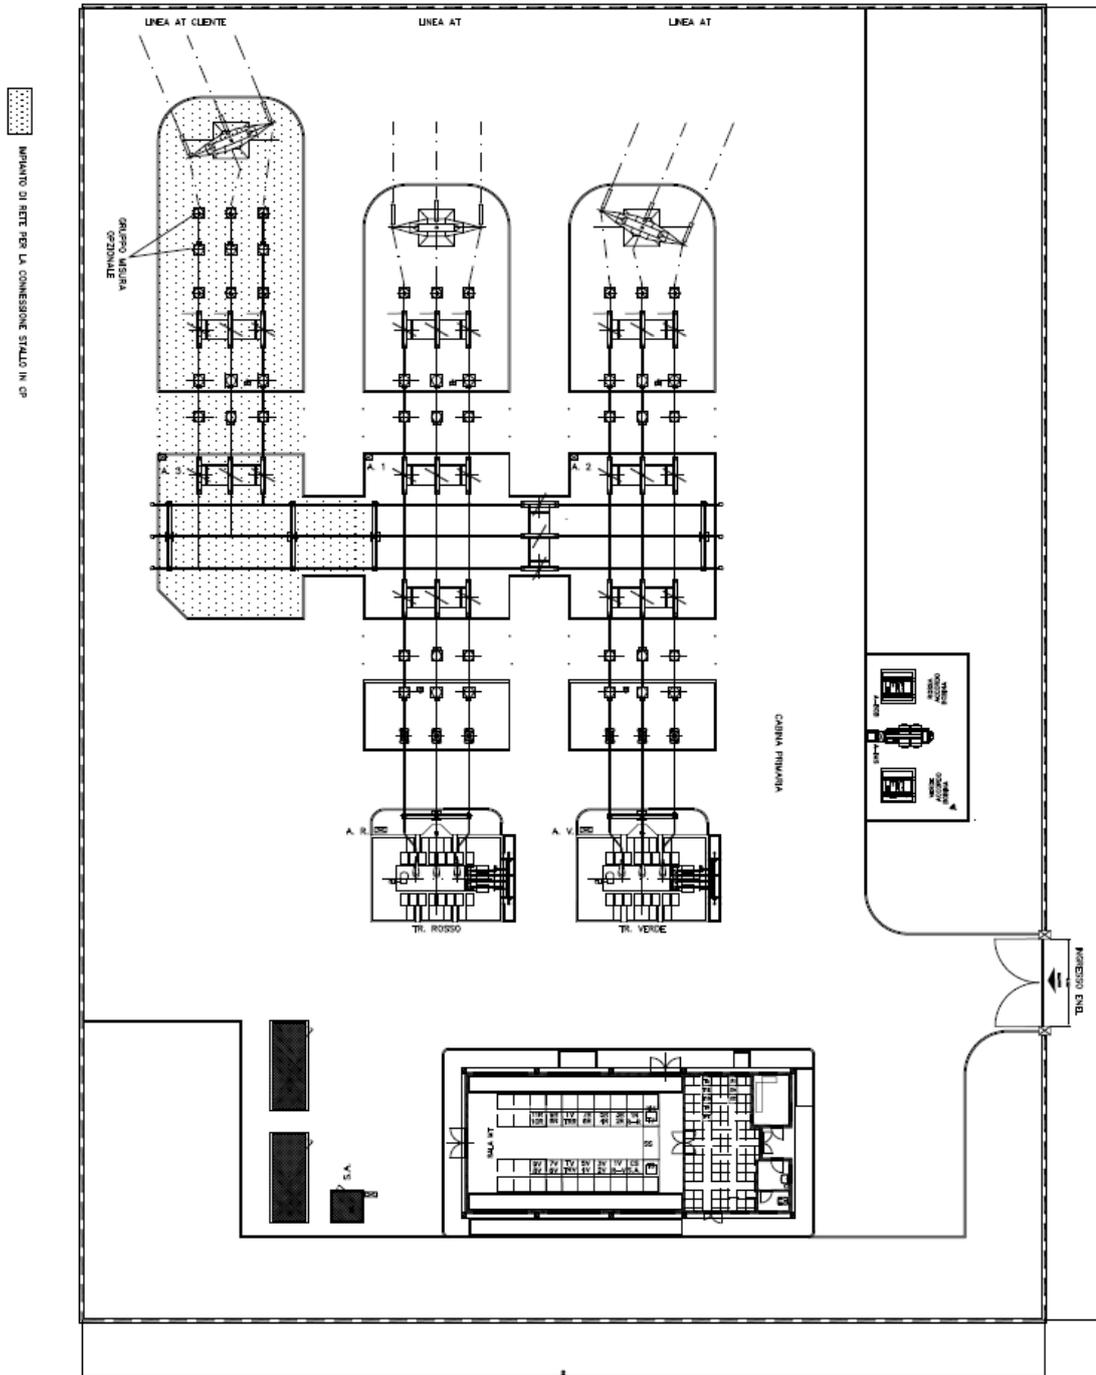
Impianto di rete per la connessione stallo in Cabina Primaria per Cliente Attivo distante da Cabina Primaria (Vista in pianta).
